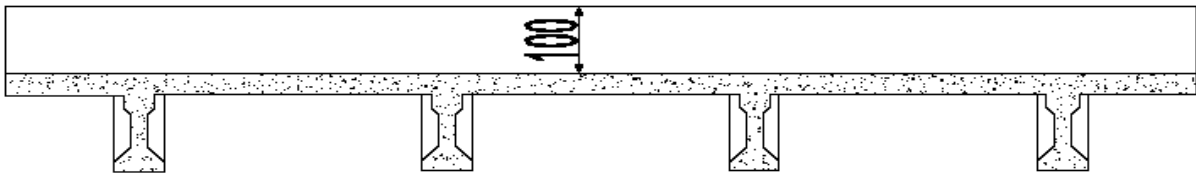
Franja de diseño para la losa de hormigón armado (dimensiones en cm).
